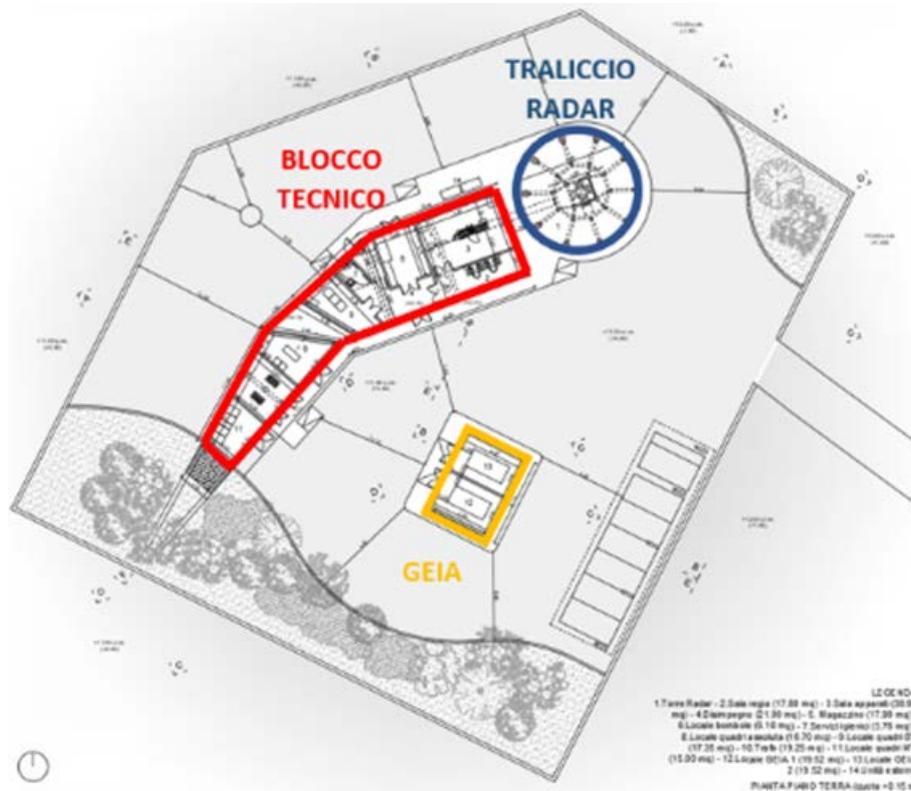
Stralcio pianta piano terra con individuazione delle funzioni
